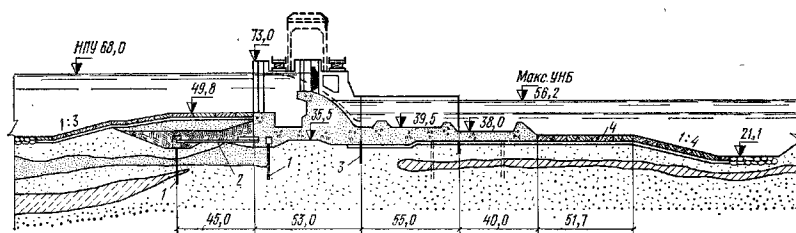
Водобросная плотина гидроузла имени В. И. Ленина на Волге
